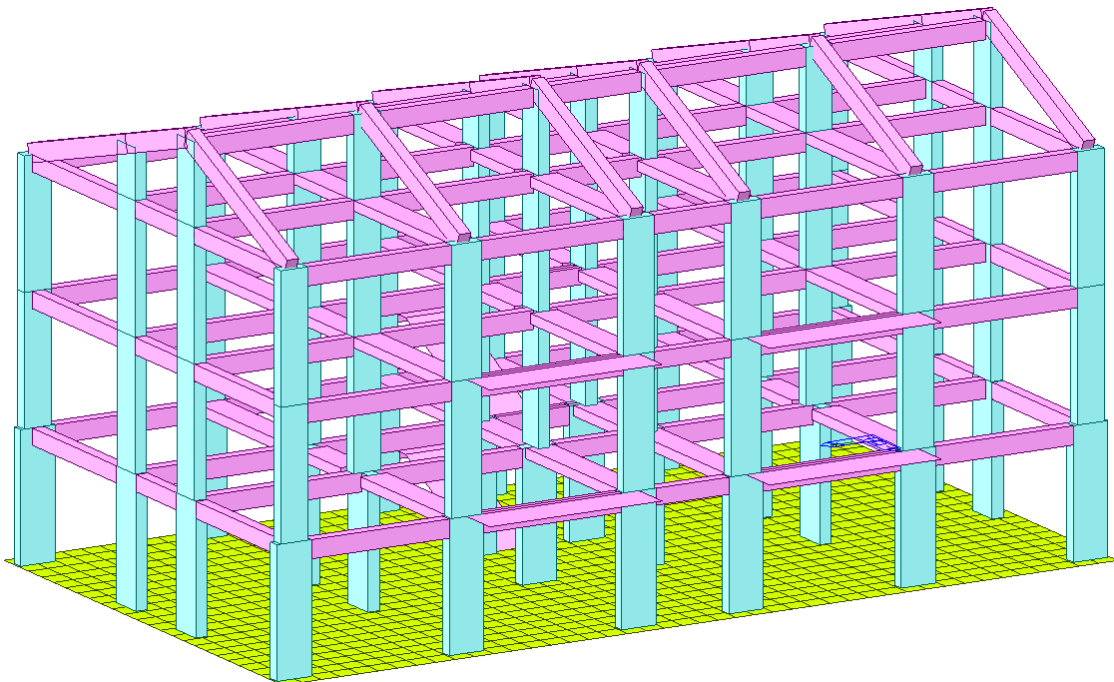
Modello FEM edificio a tre piani in c.a. con platea di fondazione - Vista assonometrica 2.
